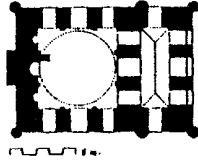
مسقط أفقى لجامع أورخان غازى
